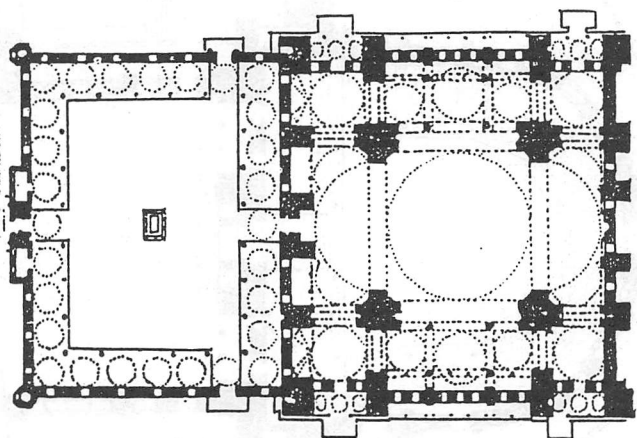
المسقط الأفقي للجامع الأخضر في بورصة .
